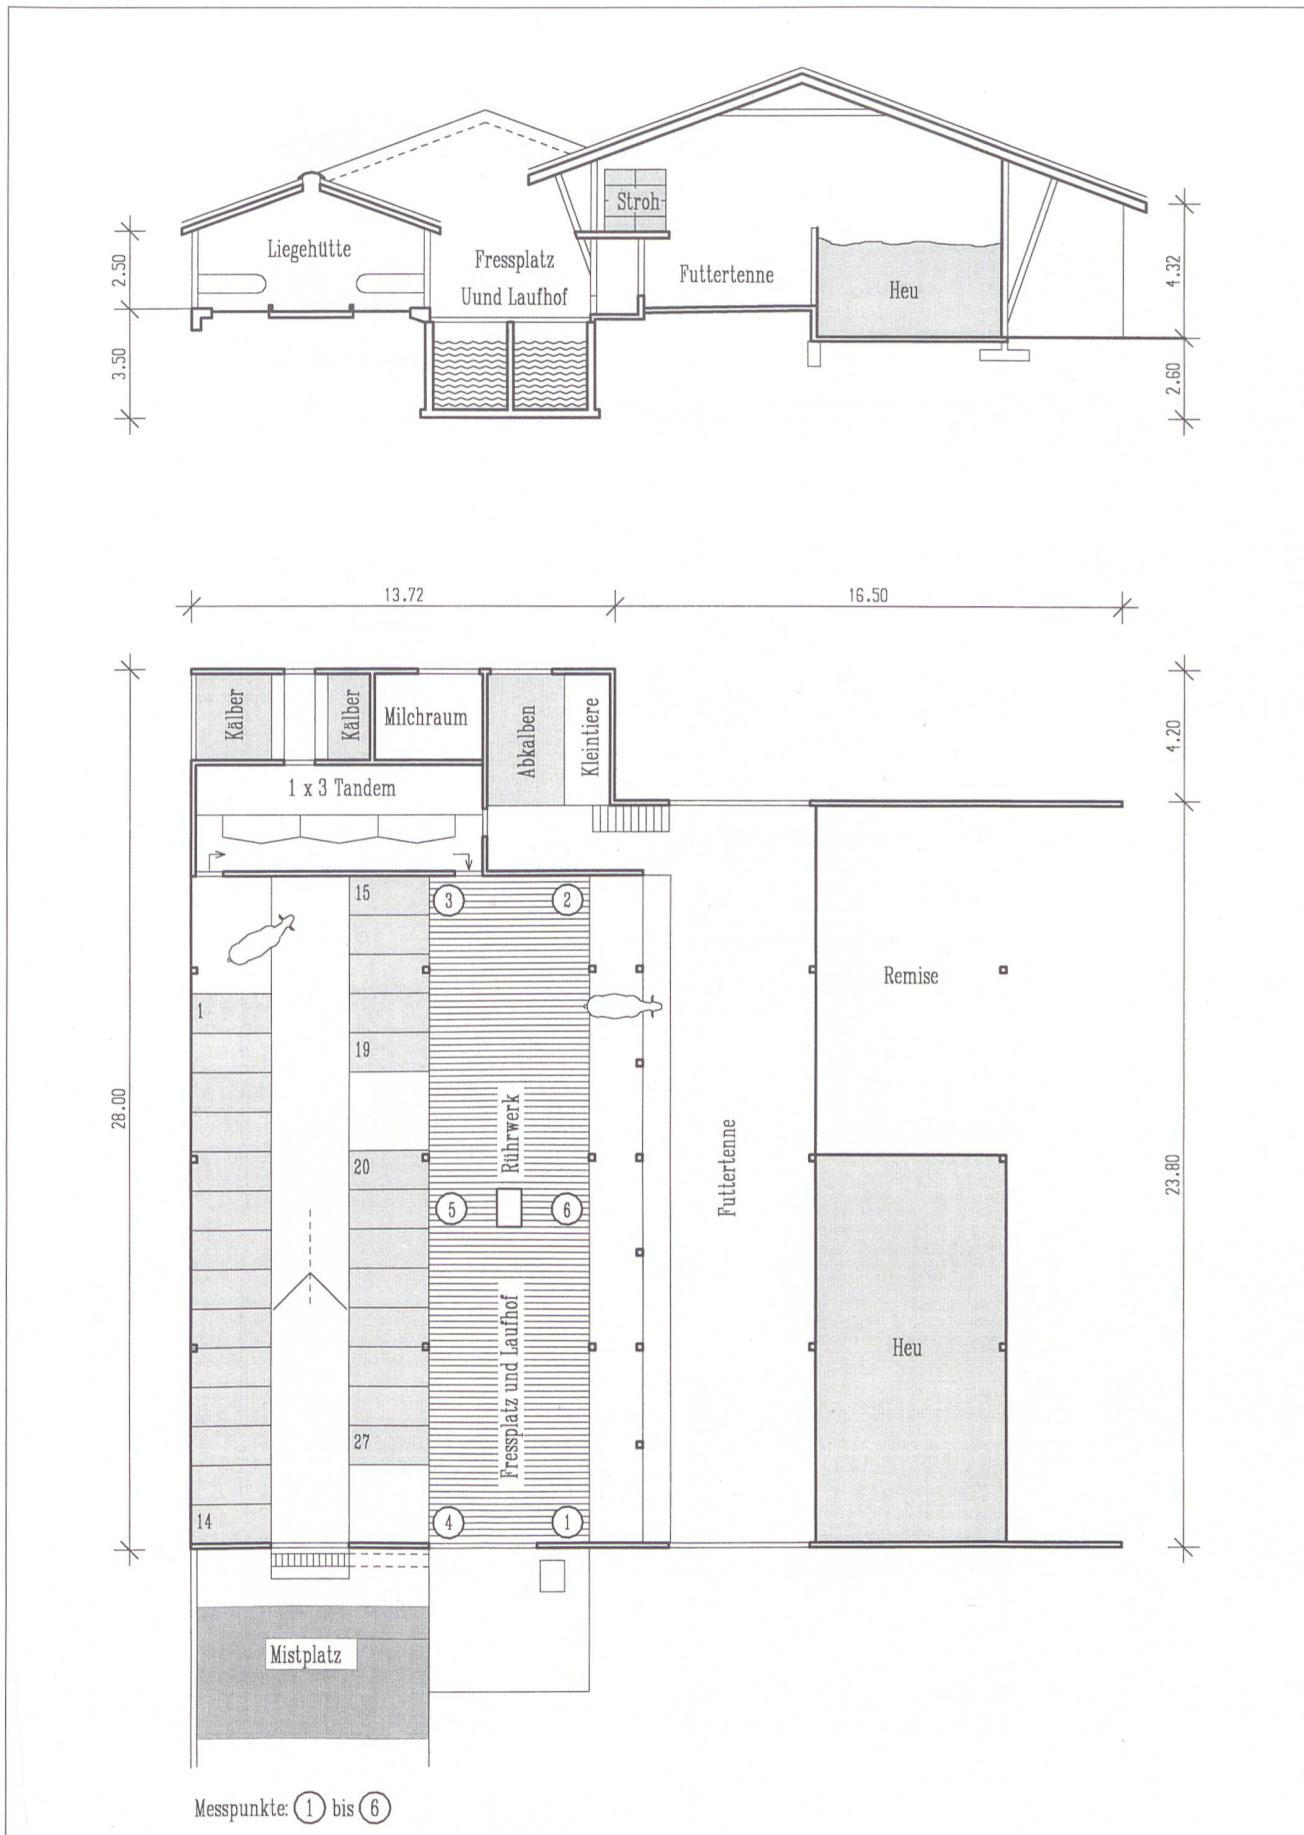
Güllegrube unter Laufhof, einseitig offen.
